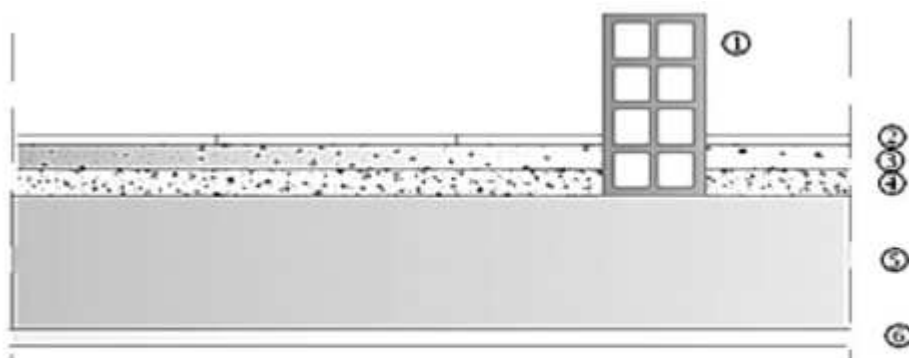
C : coupe verticale d'un plancher en dalle pleine.
